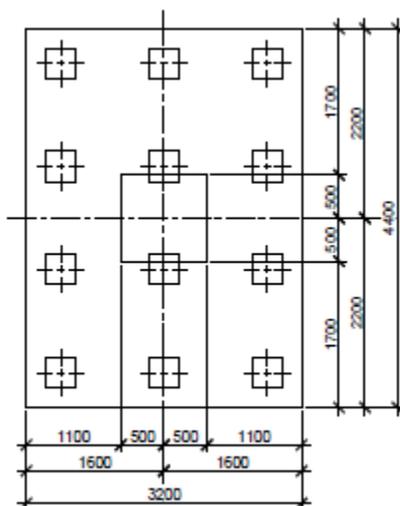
Конструктивная схема свайного кустового фундамента
